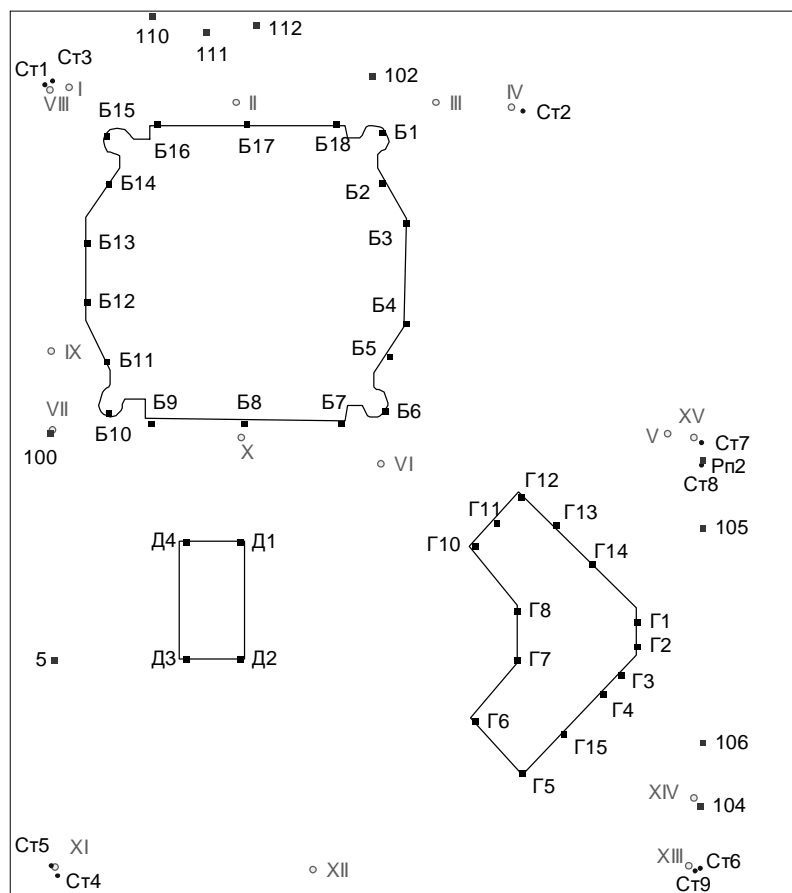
Схема размещения точек на зданиях и строительной площадке
